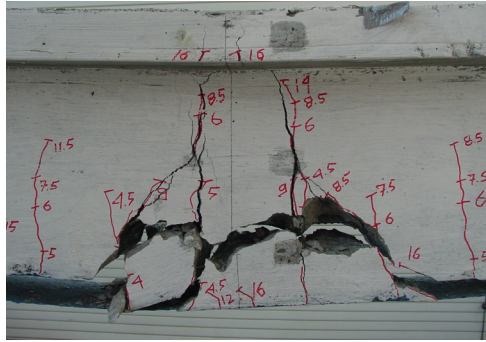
Descolamento do FRP devido fissuras de flexão (Silva Filho, 2004)
